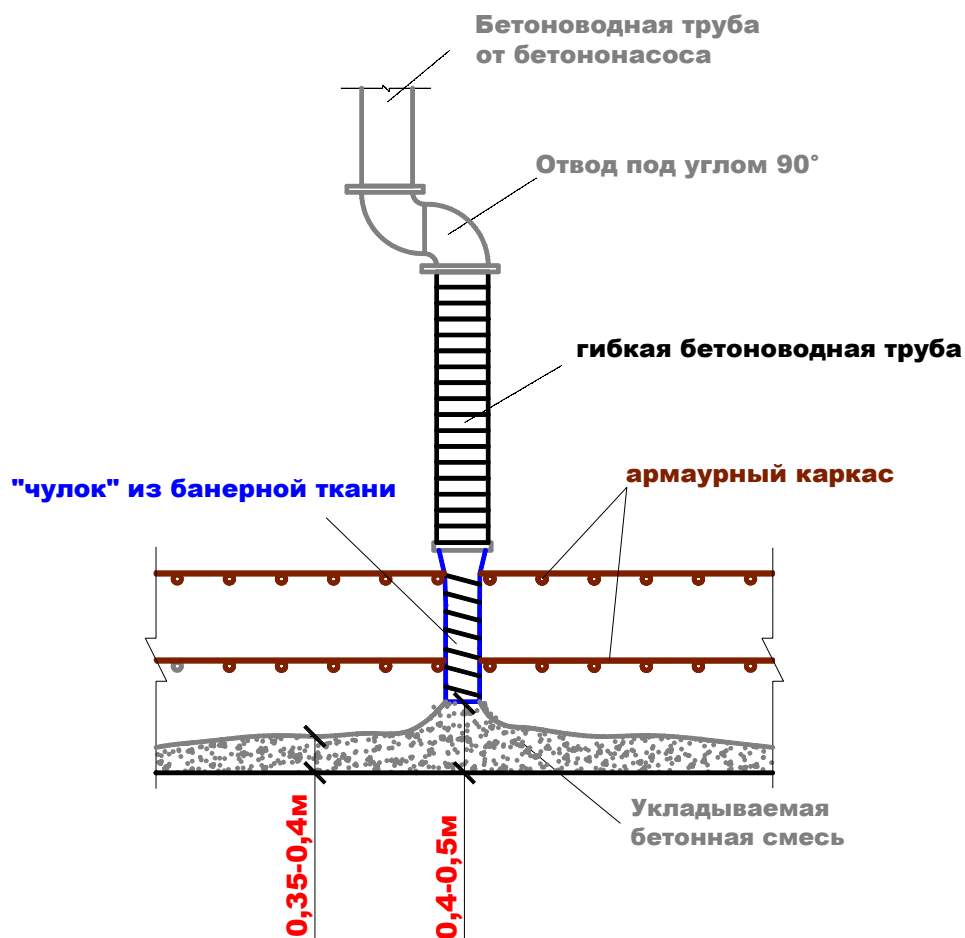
Схема подачи бетонной смеси в блок по бетоноводу с установленным на нем отводом – коленом под углом 90° и «чулком» из банерной ткани.
